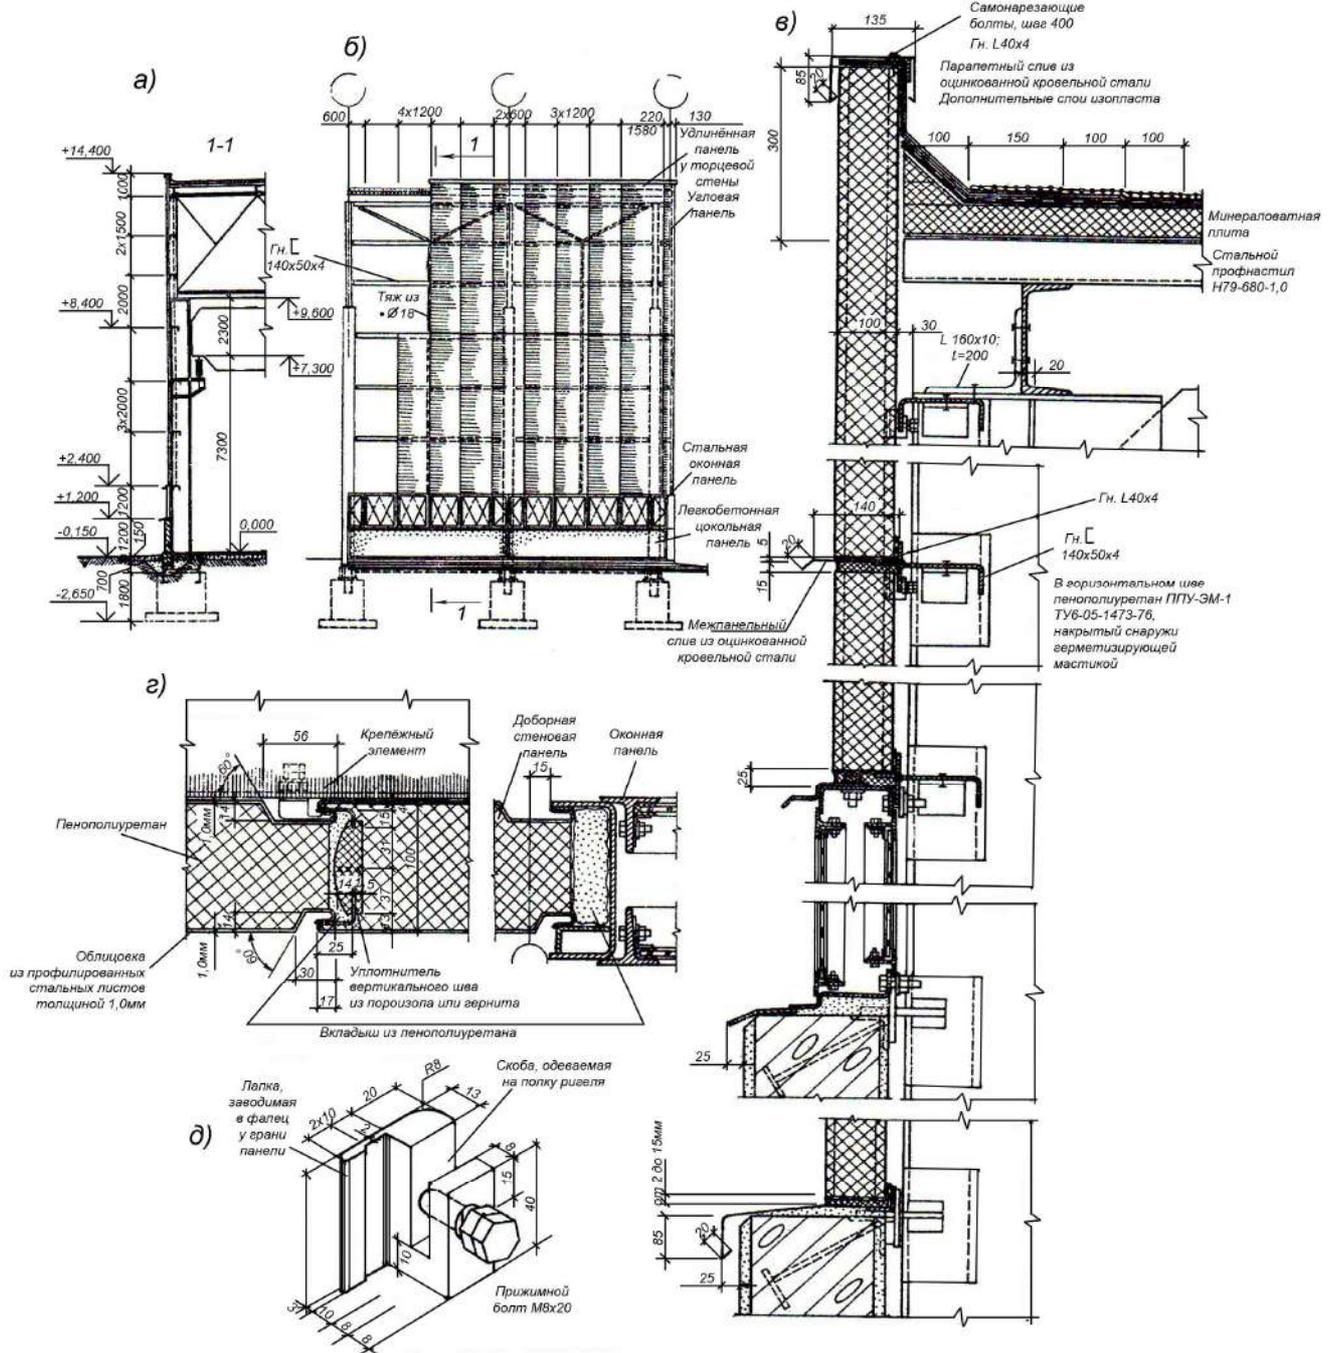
Стены одноэтажных промышленных зданий из металлических трехслойных панелей типа «сэндвич»:
